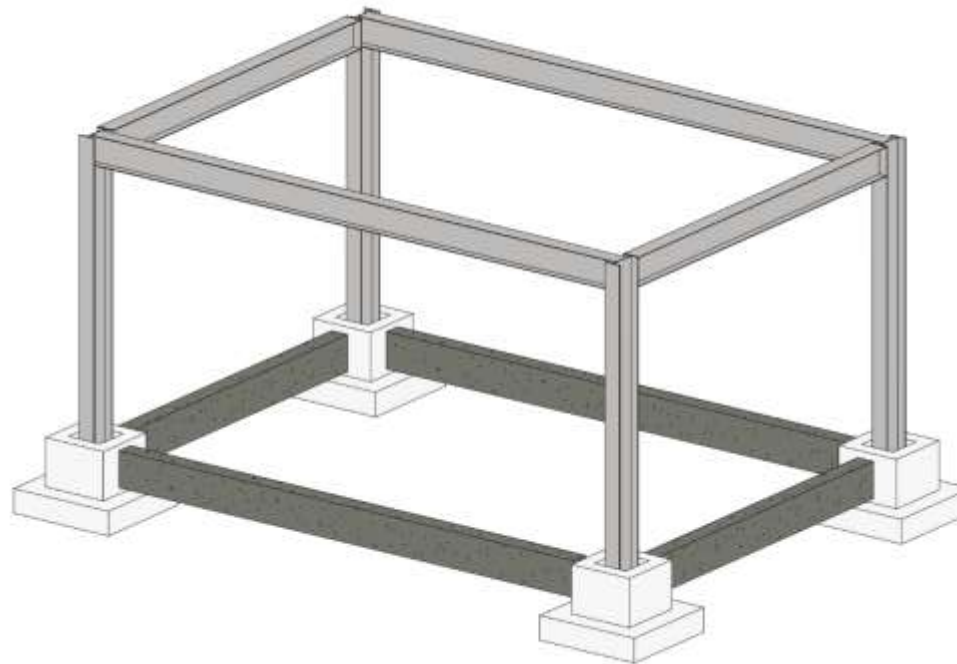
Modelo de cimentación con zapata aislada y estructura de marcos rígidos de aceros propuesta para el proyecto. Elaboración propia.
